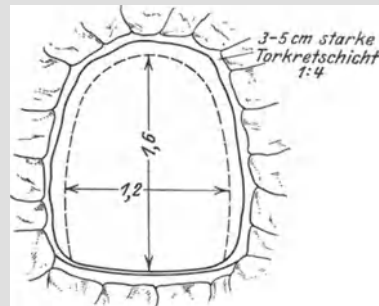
Stollen in festem Gestein, durch Torkretierung gedichtet. Maßstab 1 : 55.
